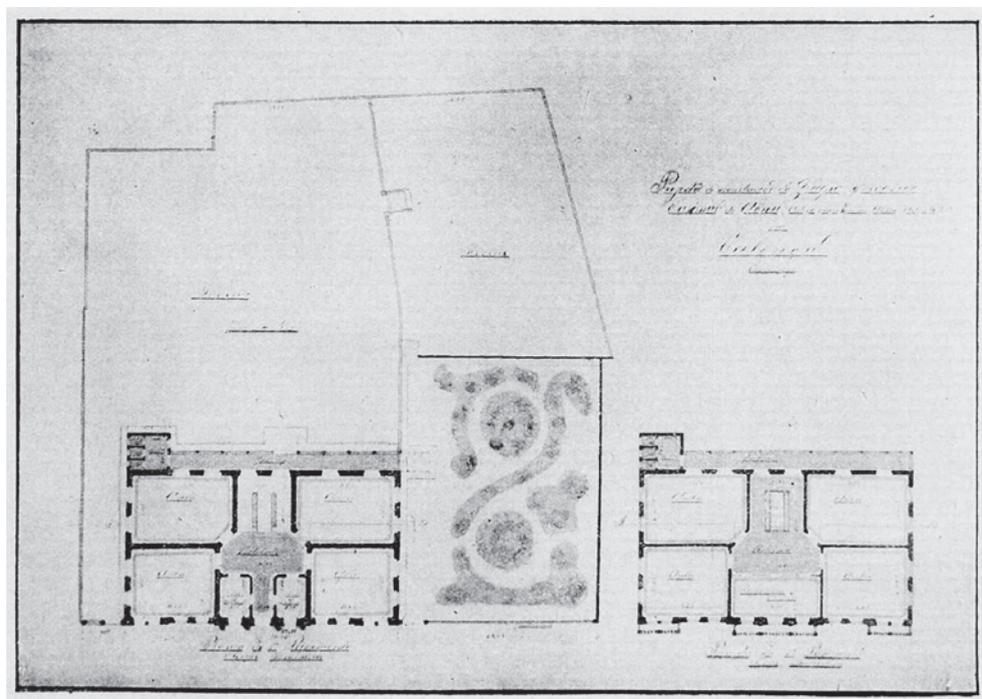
Planta baixa dos 1º e 2º pavimentos do G. E. Casimiro de Abreu, em Valença
